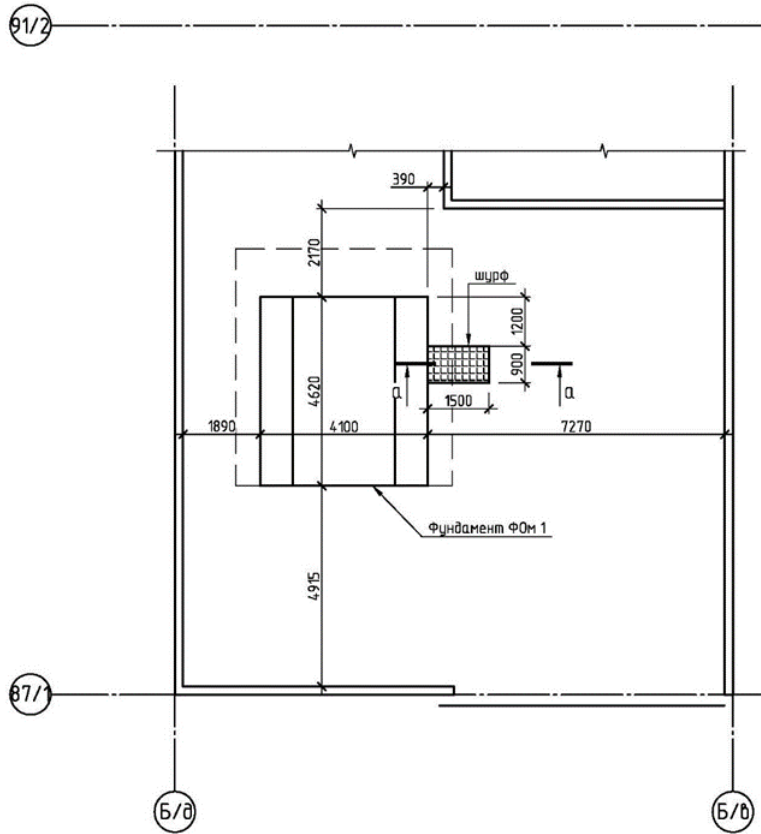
Привязка фундамента ФОм 1 в плане к стенам здания (с расположением шурфа)
